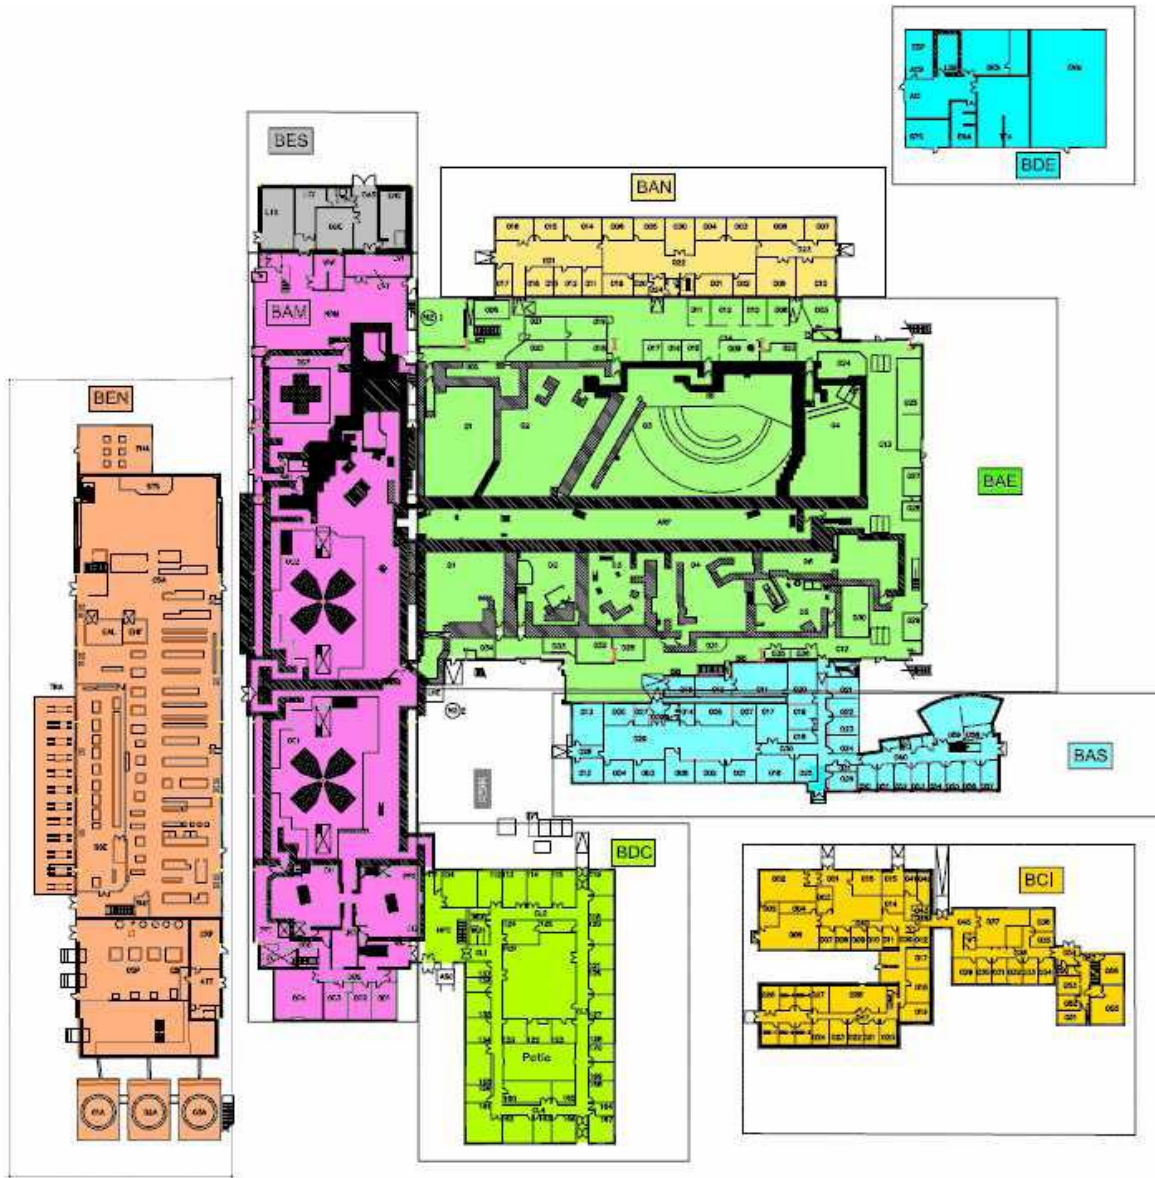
plan de l'installation (sans son extension SPIRAL2)
